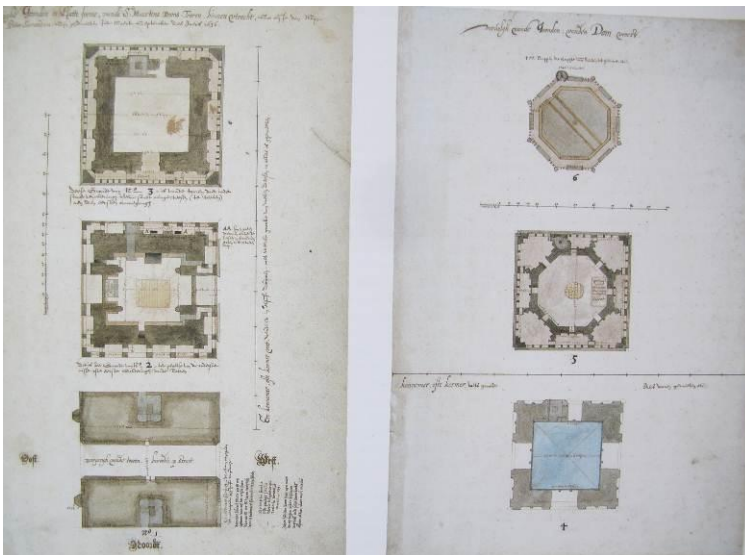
Pieter Saenredam, Grundrisse des Utrechter Domturmes (um 1636), je 41,5 x 28 cm, Archiv Utrecht
